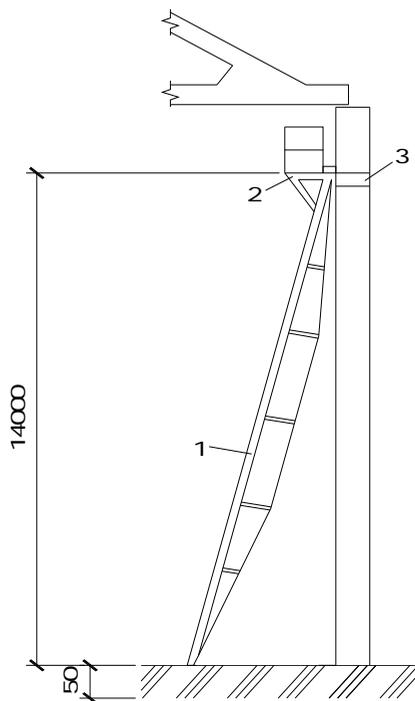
Монтажные лестницы с площадками с несущей конструкцией в виде шпренгеля:
